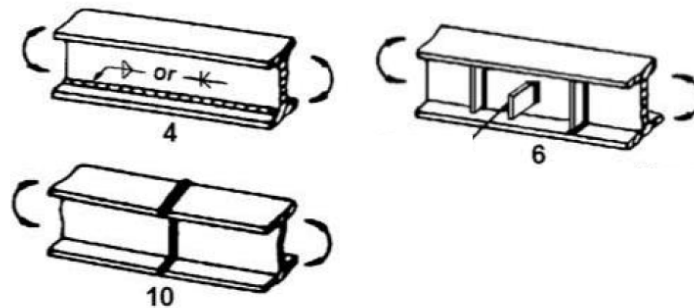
Exemplos de detalhes referentes a este trabalho: Solda da mesa inferior com a alma (B); solda do enrijecedor transversal (C); solda de topo entre os perfis (B).[2]
